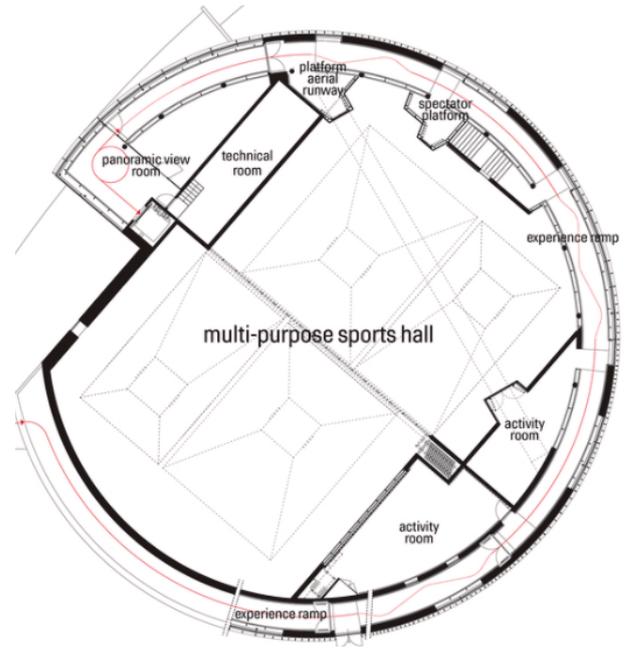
Planta, Extensión Musholm. Fuente: Archdaily.com
